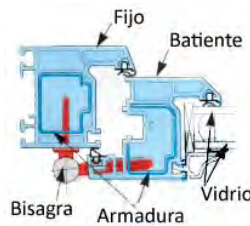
ARMADURA DE ACERO EN MANGUETES DE PVC
